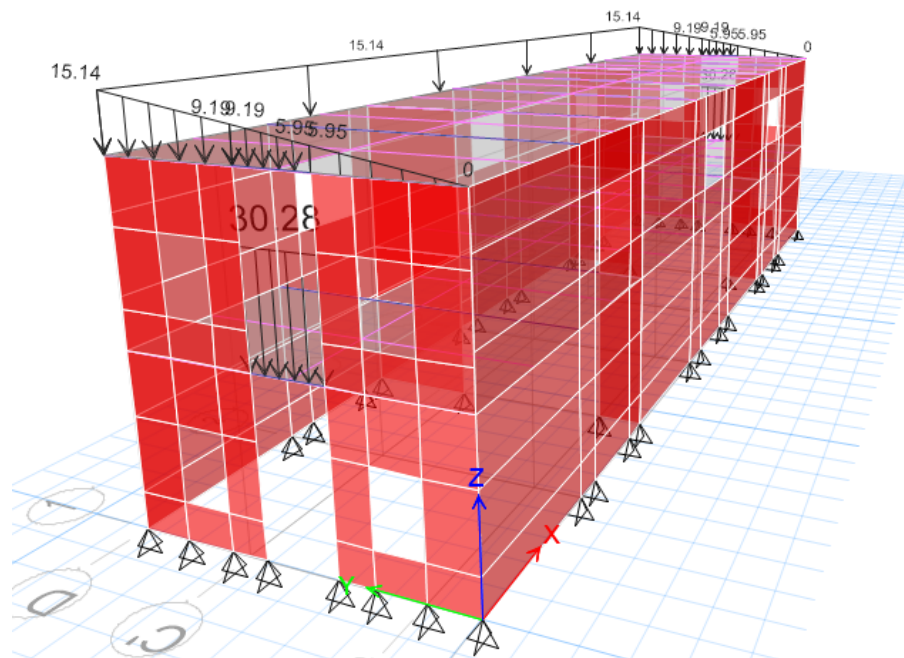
Cargas de Parapeto asignadas a la estructura
